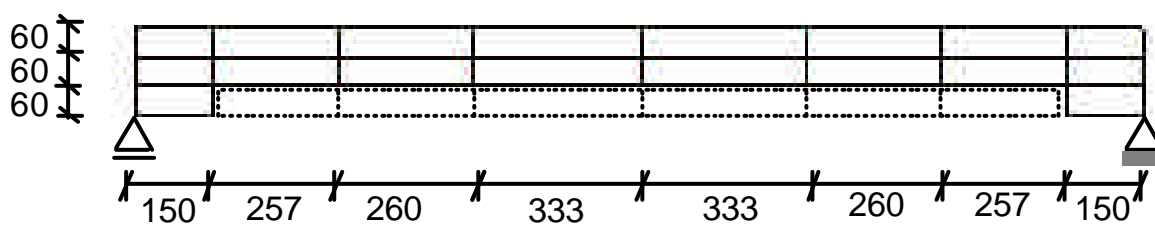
Malha de elementos finitos adotada para a viga com armadura exposta em um trecho de 170 cm
